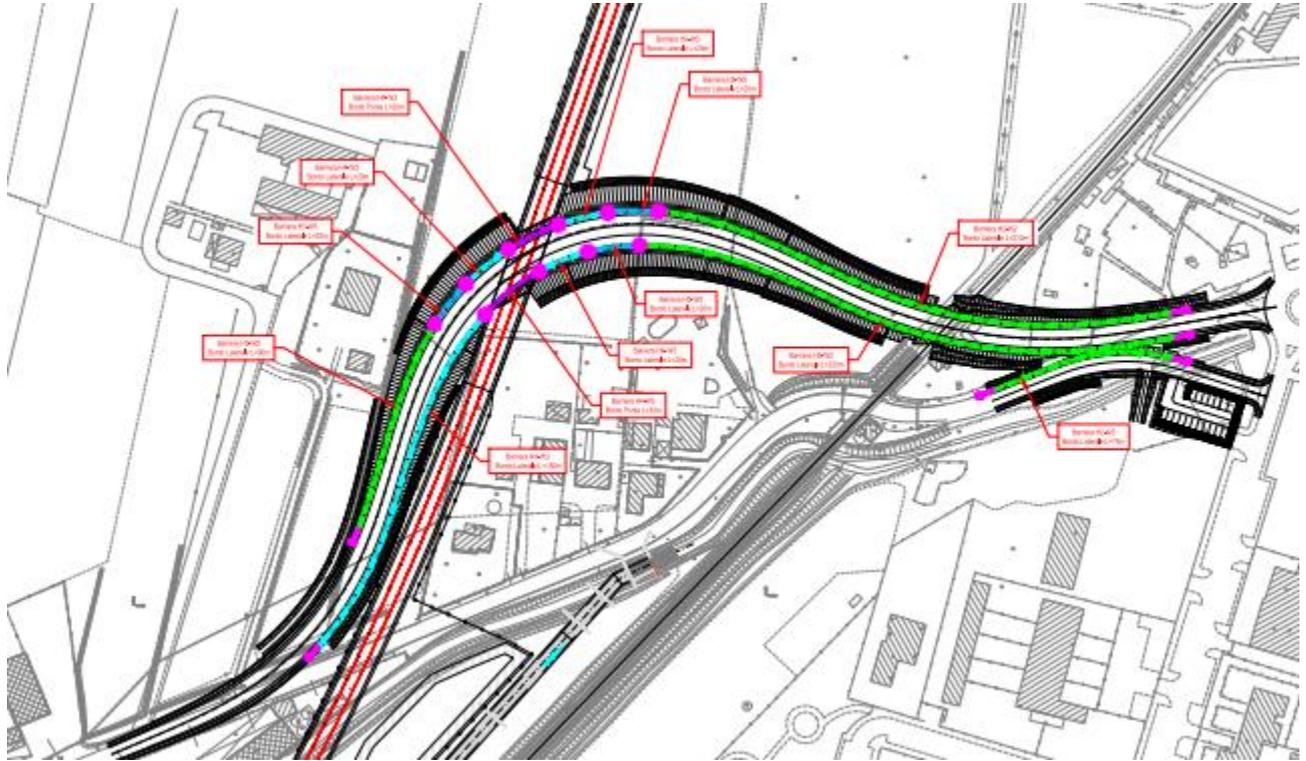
Stralcio planimetrico della tipologia di barriere lungo il tracciato della viabilità NV04
